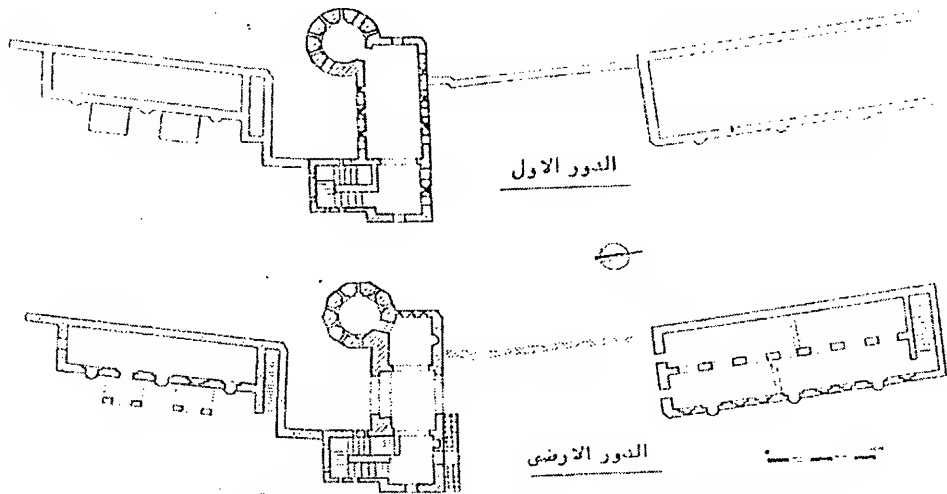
زبيد، المسقط الأفقي لباب سهام
